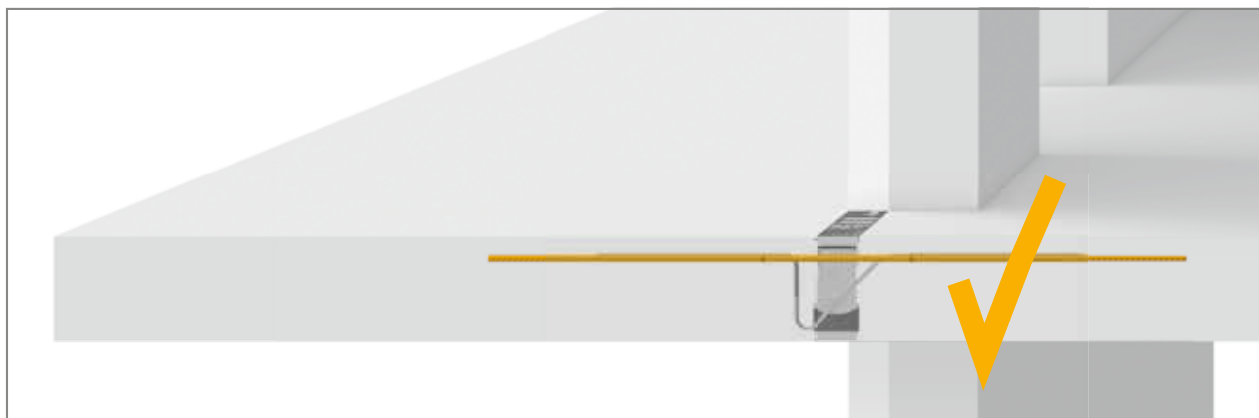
Schöck Isokorb® T tipo KL e la posa corretta: barra tesa sul lato superiore
